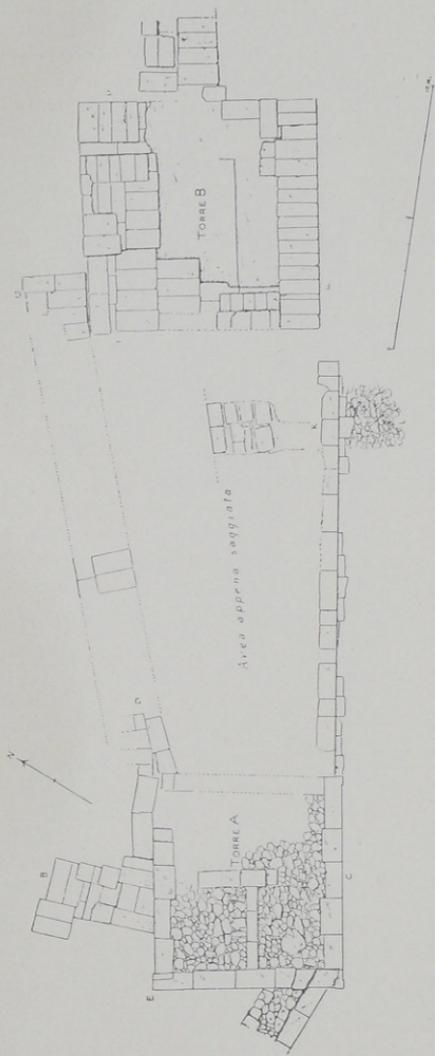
Colle S. Mauro. Pianta delle torri.
